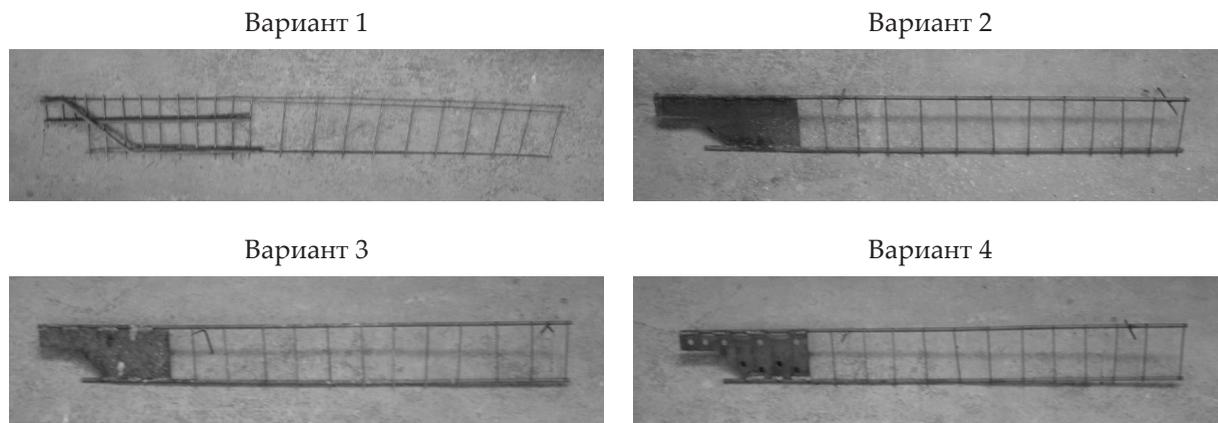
Каркас поперечного армирования плиты, варианты 1–4
